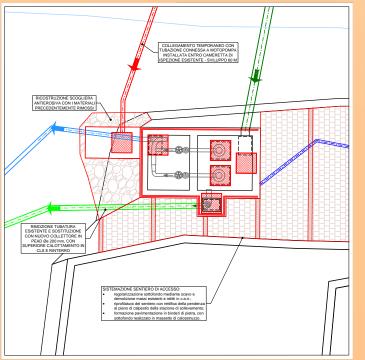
Stralcio planimetria di progetto stazione di sollevamento CP01
